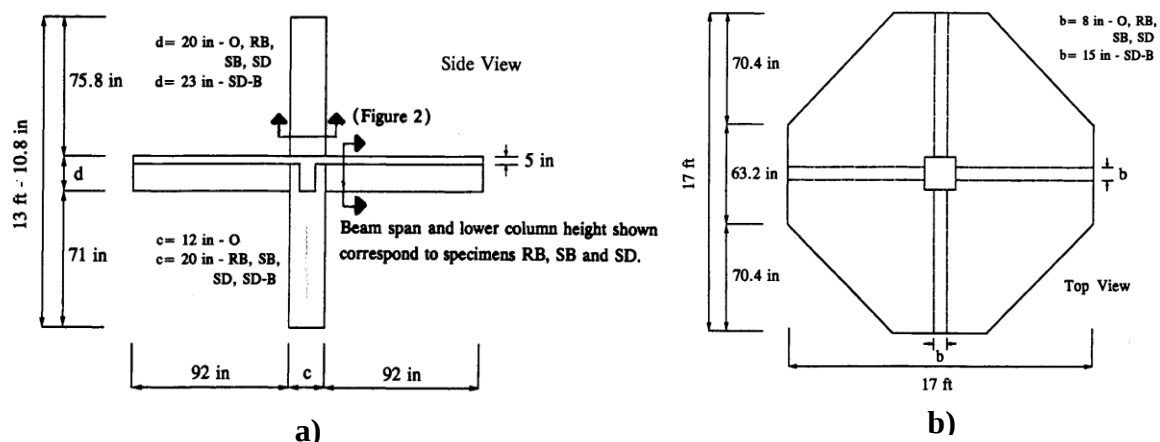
Características geométricas de especímenes; a) vista en corte y b) vista en planta, retomado de Jirsa y Alcocer (1993).
